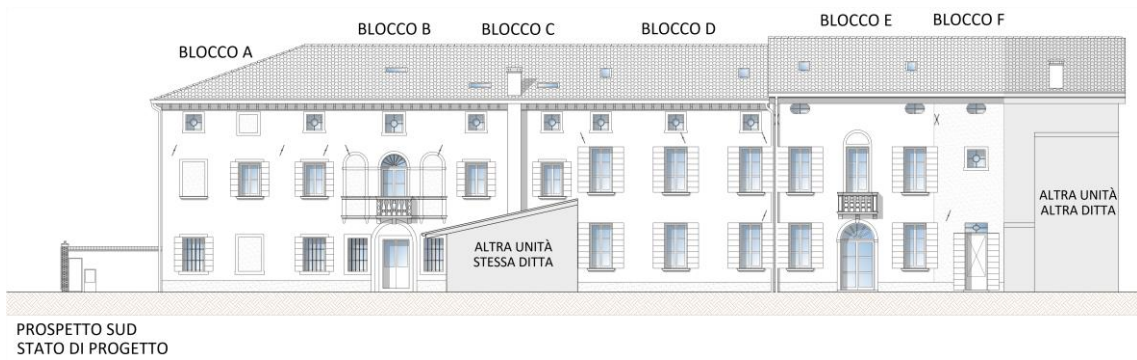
Prospetto Sud - Stato di progetto - scala generica
